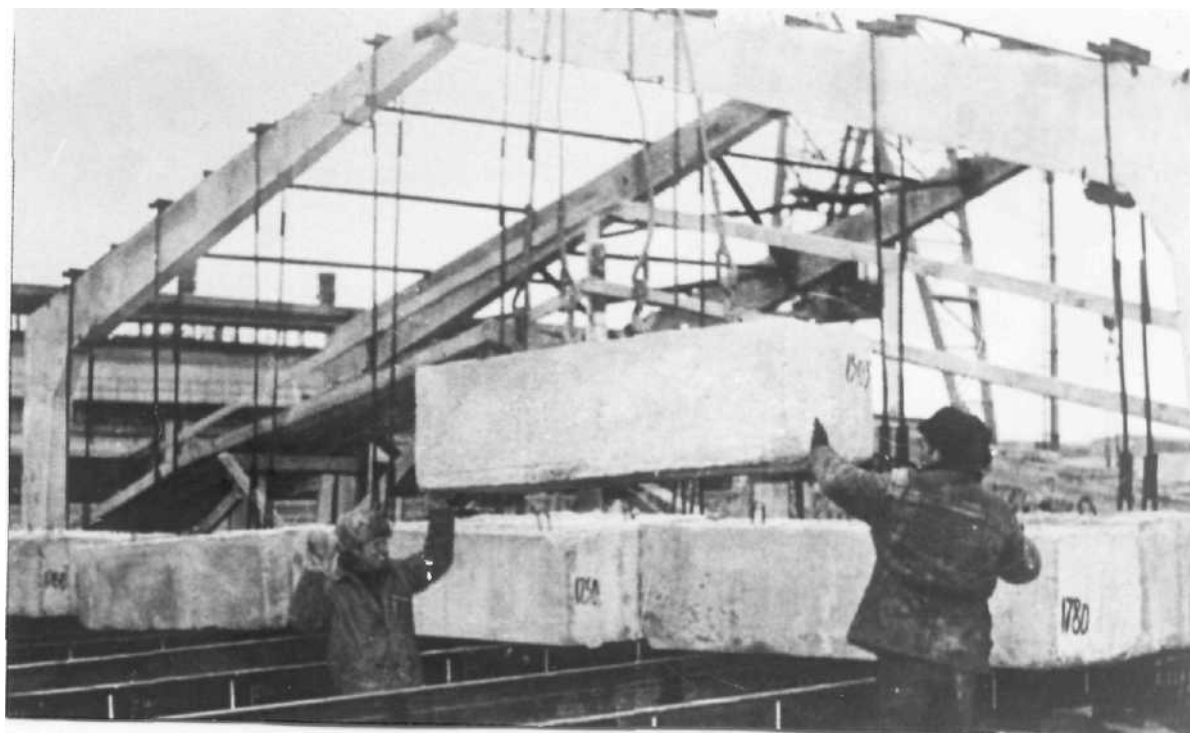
Завантаження рами прольотом 12 м фундаментними блоками
